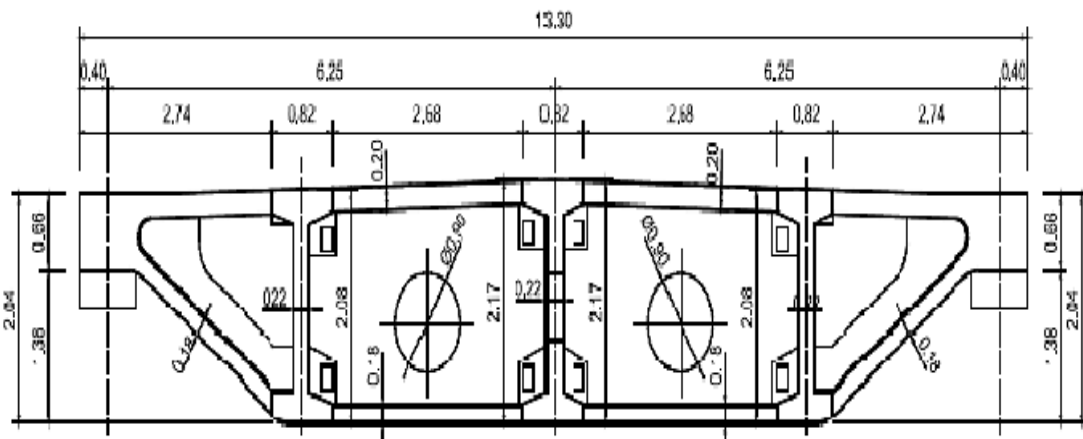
Section transversale du tablier du pont à haubans sur l'Oued Dib à Mila
